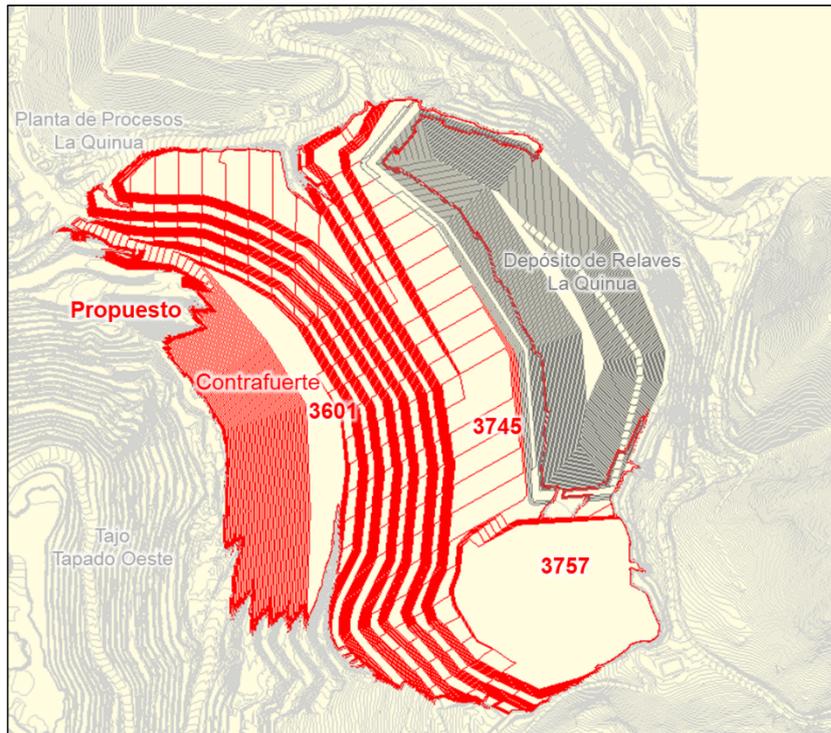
Plan de descarga del Relleno La Quinua propuesto – Año 2027 – Vista en planta
